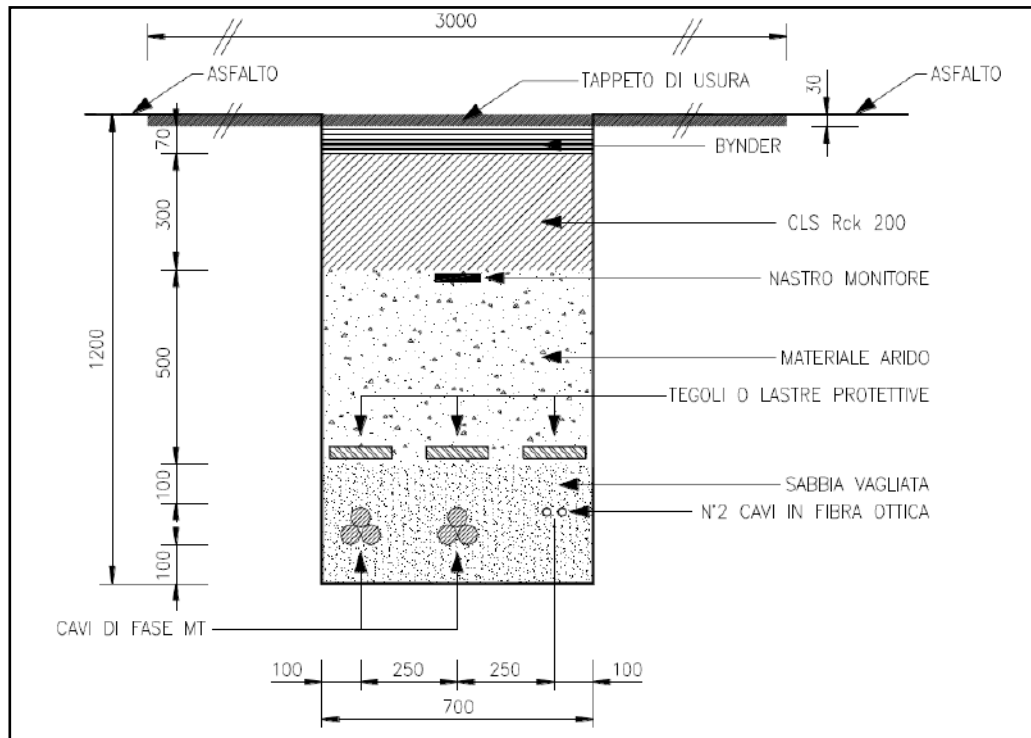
Sezione tipica di posa della linea in cavo su sede stradale
